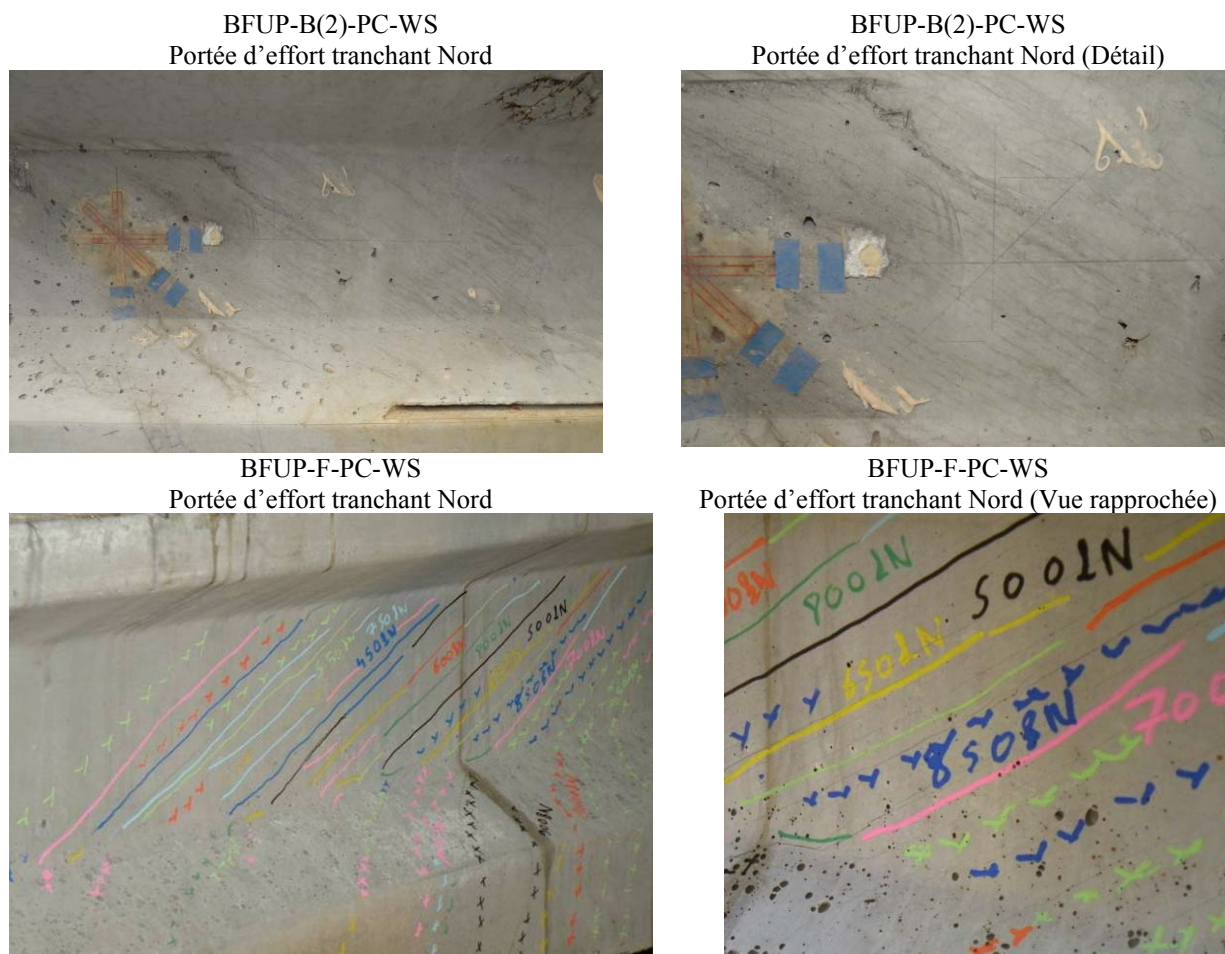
Exemples de multifissuration diagonale : poutres BFUP-B(2)-PC-WS et BFUP-F-PC-WS
